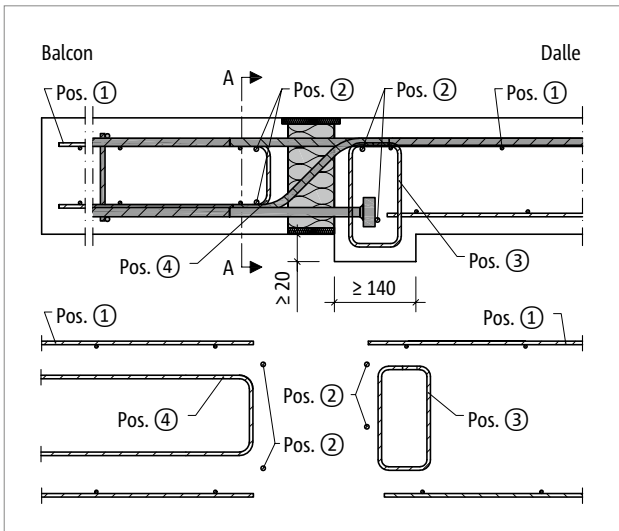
Schöck Isokorb® T type K-T-M13 : renforcement sur site pour support indirect
